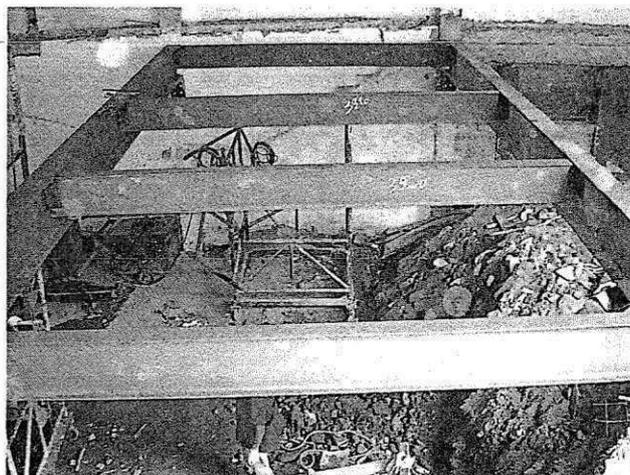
Vigas metálicas do 1º pavimento na Obra C&A
